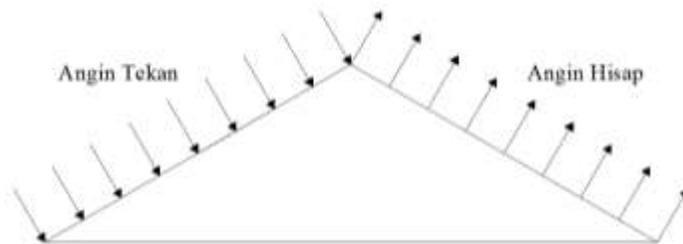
Pengaruh Angin pada Bangunan Gedung
